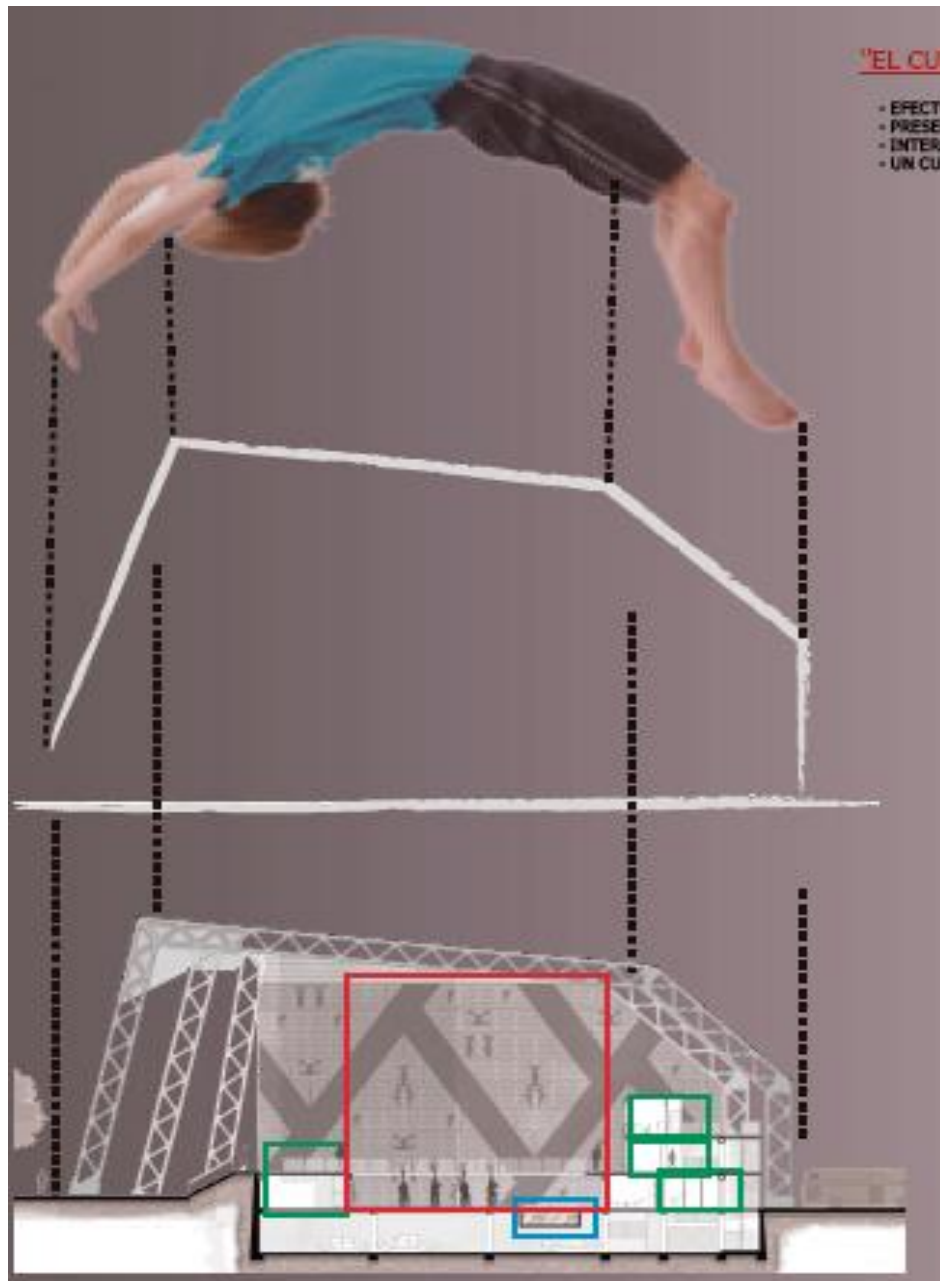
Geometrización figura Backhandspring. Elaboración propia.
